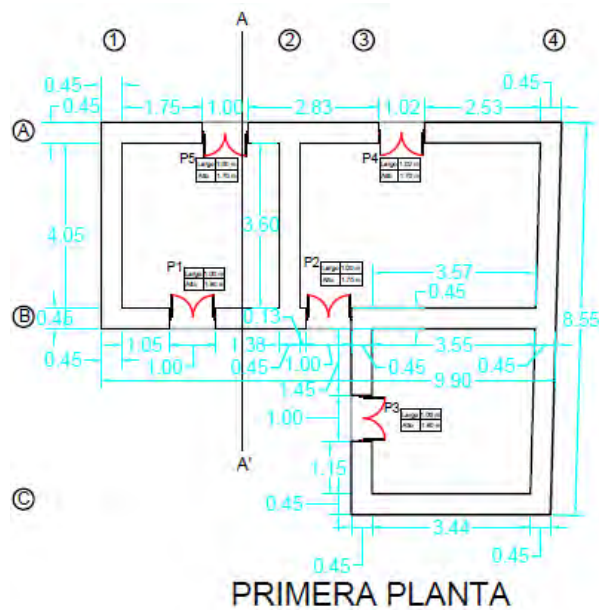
Configuración arquitectónica en "L", plano en planta de la vivienda encuestada n° 10. Fuente: Fuente: Elaboración propia, 2019.
